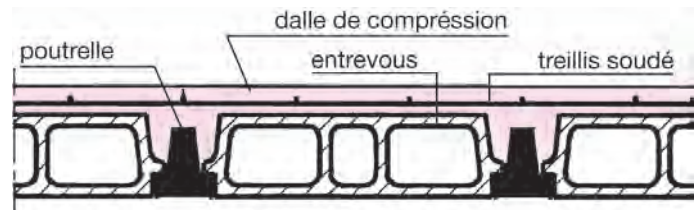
Détail d'un plancher à poutrelles précontraintes
